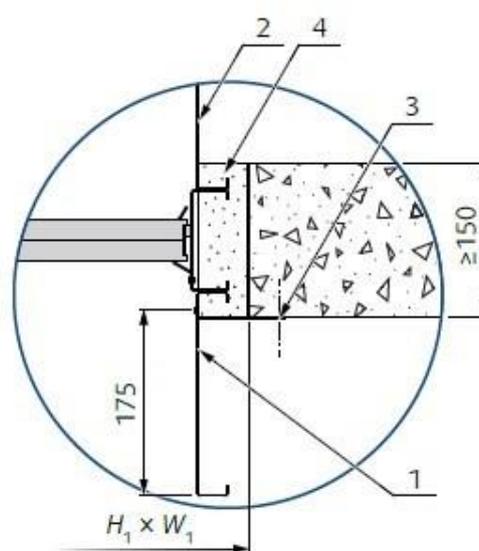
(EI120S) Sezione trasversale per installazione a umido in pavimenti/solette rigidi (attuatore sotto)
